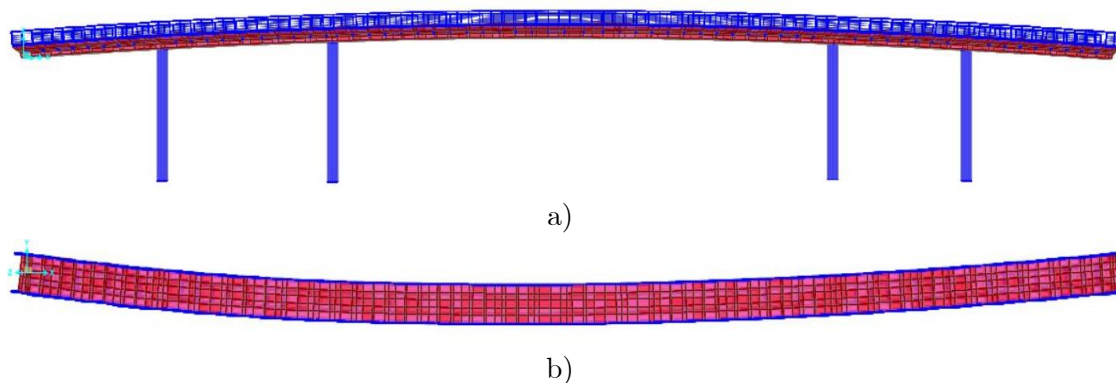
Modelo numérico de elementos finitos tridimensional da ponte pedonal: a) vista lateral; b) vista de planta.
